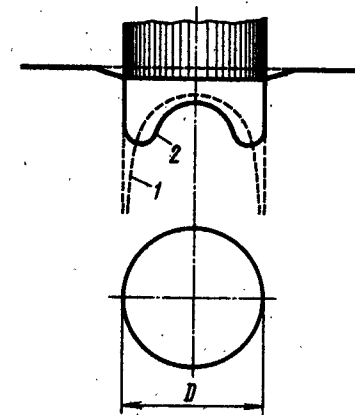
Седловидная эпюра распределения напряжения по подошве круглого жесткого штампа при работе грунта в упругой стадии:
